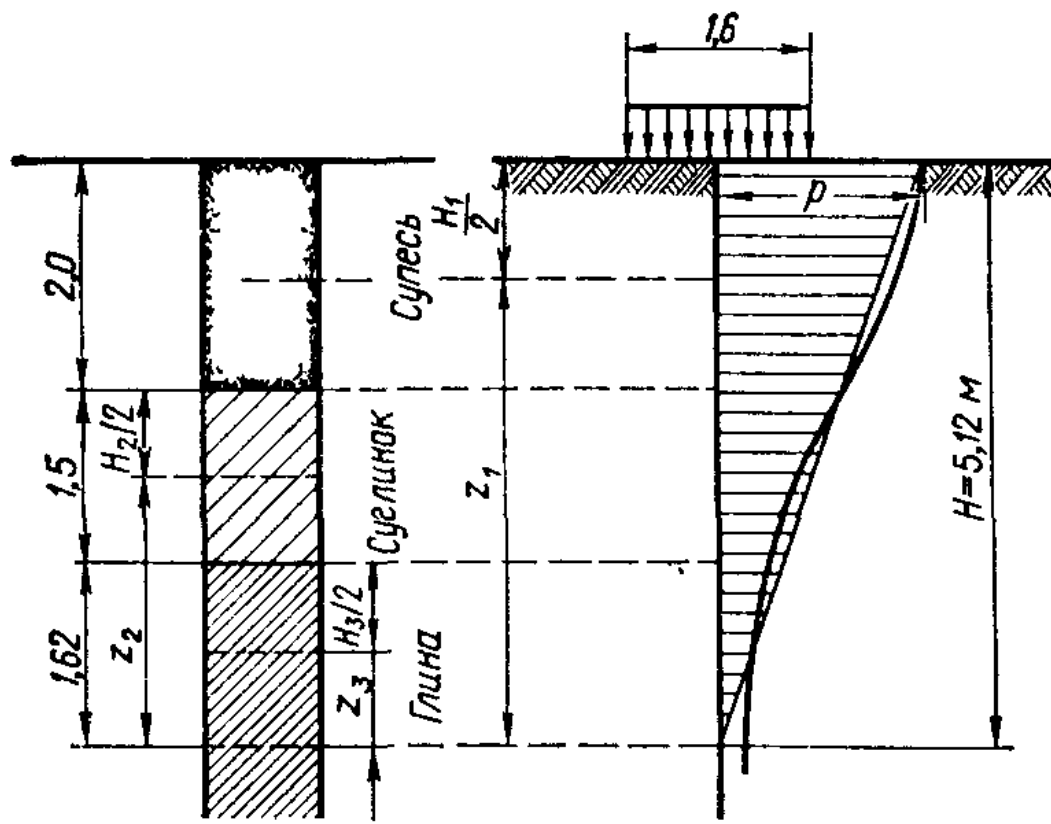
К примеру расчета осадок фундамента на слоистых напластованиях грунтов
